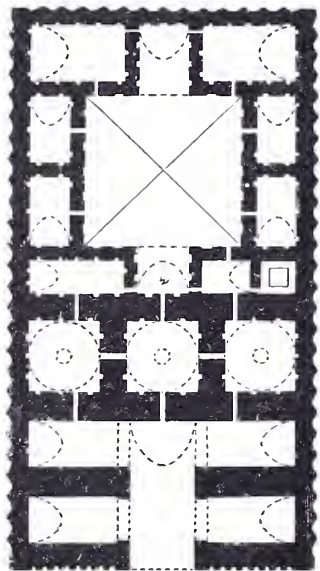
Grundriss des Palastes von Siruz-Abad. Nach Spiers.
